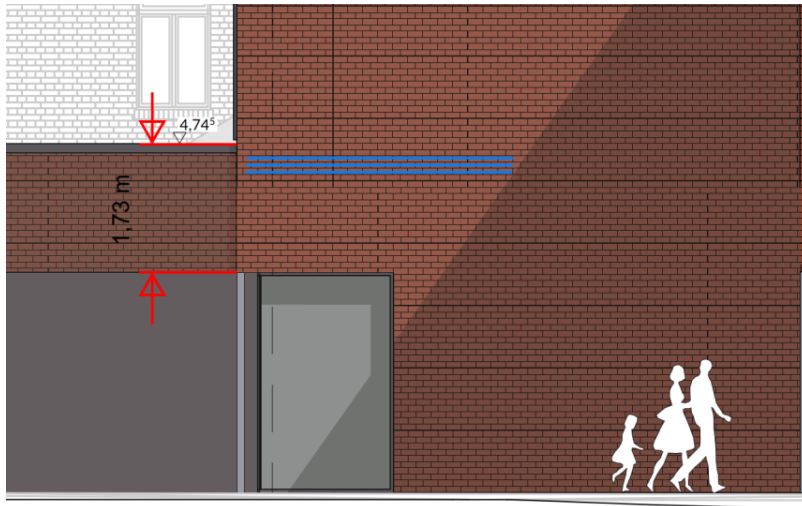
Skizze Bewehrung (blau) 3 Lagen je 2 Ø 14
